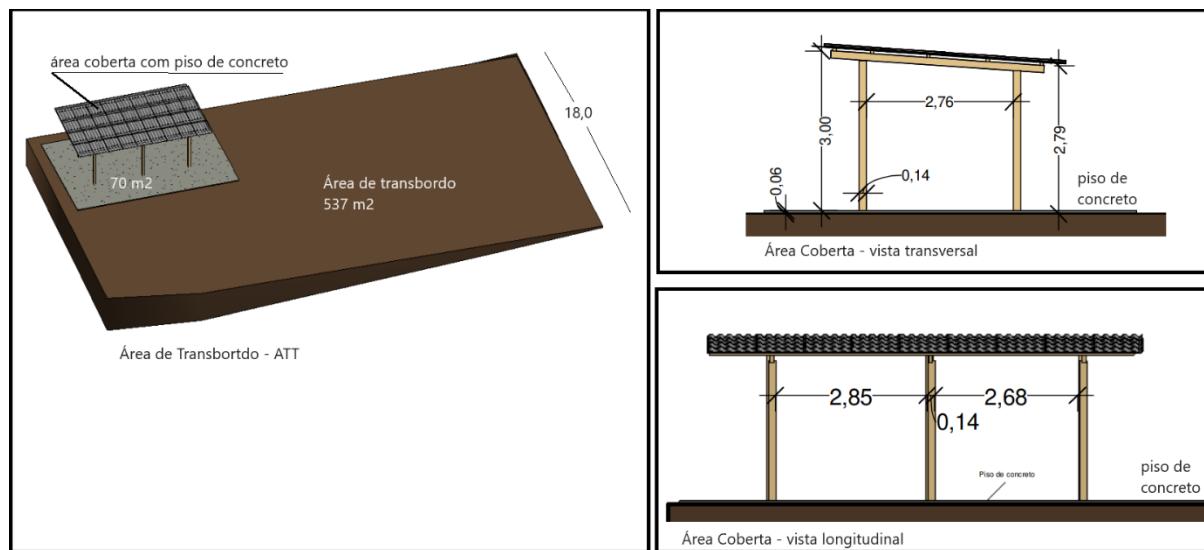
Lay-out da Área de Triagem, transbordo e área de armazenamento transitório em destaque, com piso de concreto e cobertura. Fonte: SLA
